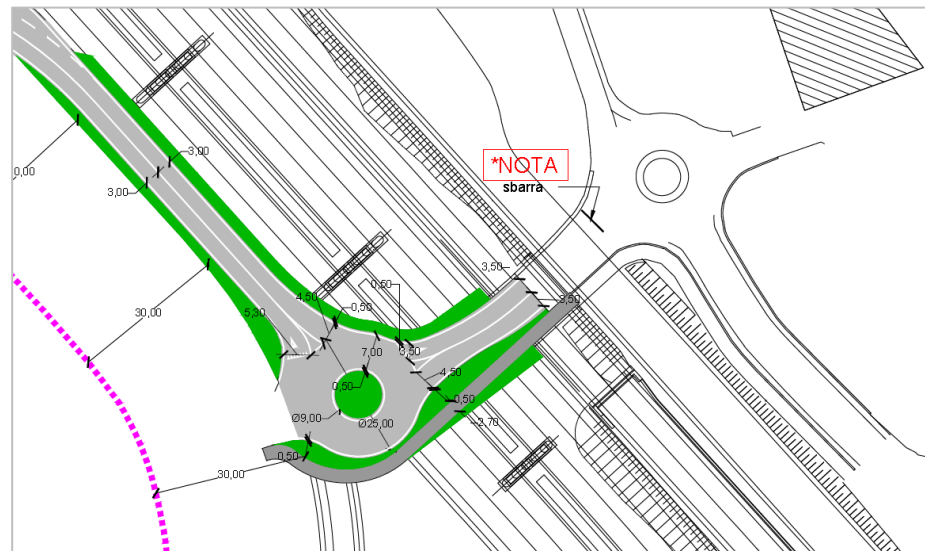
Rotatoria a est dell'Area di intervento – Ipotesi 1 – Planimetria di progetto
